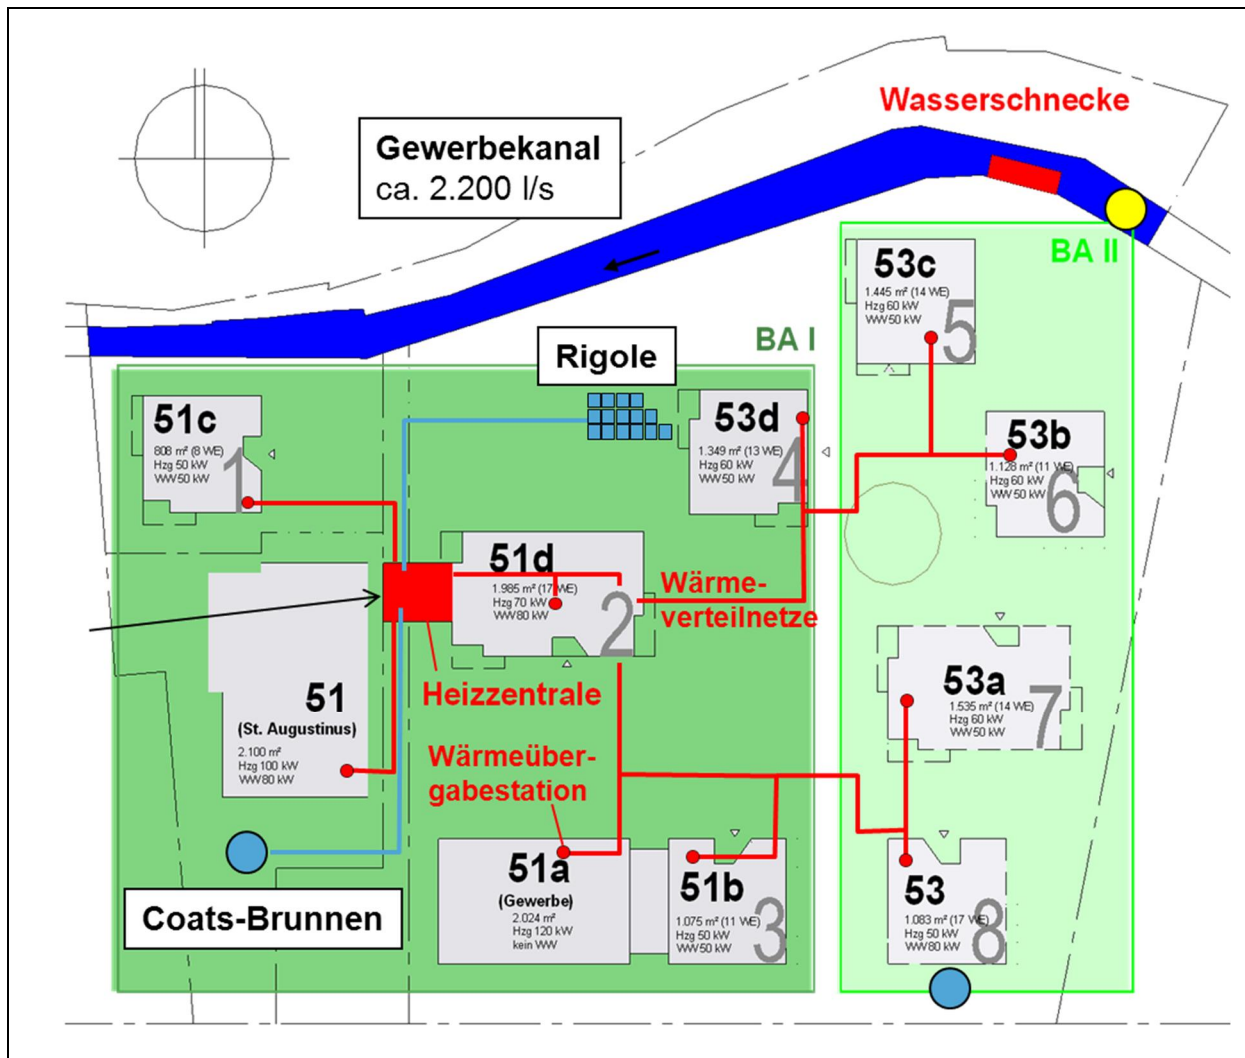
Lageplan Baugebiet Terrort Areal mit Nahwärmeversorgung
